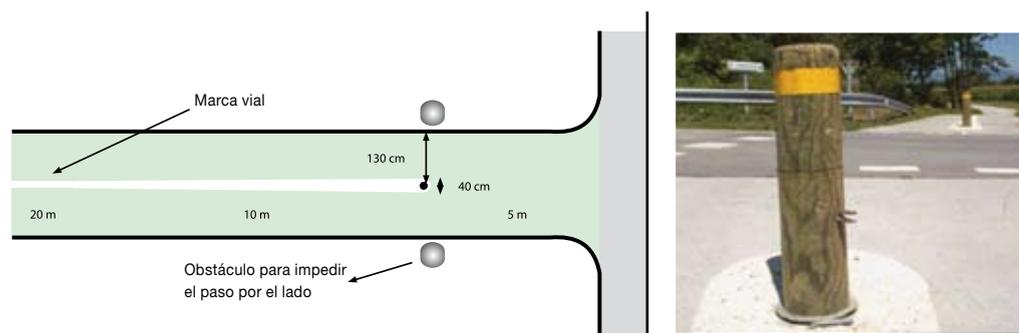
Restricción de paso por piloto central abatible *Imagen 15.- Piloto abatible
